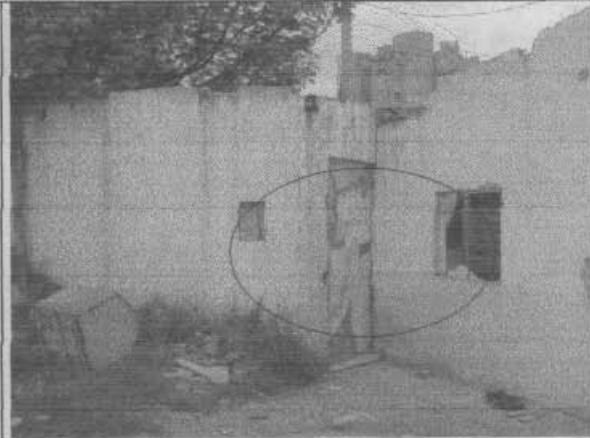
Construcción en mampostería ubicada hacia el costado sur occidental del predio.
